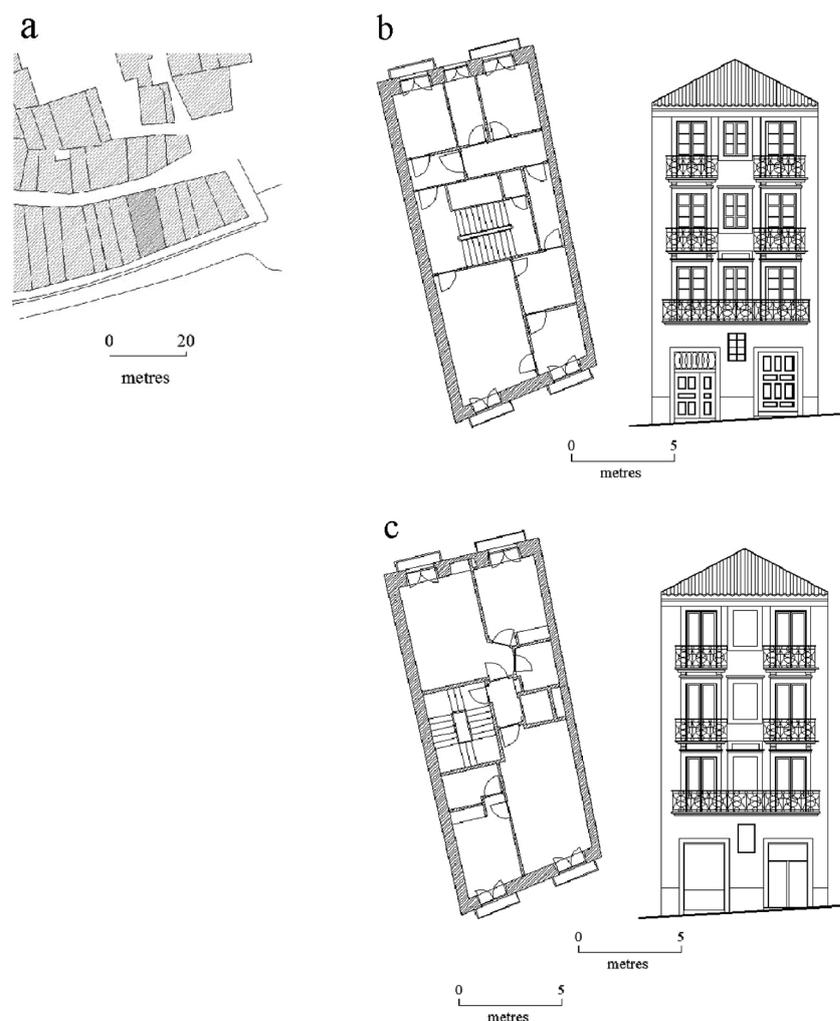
Transformação da estrutura interna e da fachada. Transformation of internal structure and facade. (a) Location plan. (b) Floor plan and northern facade before transformation. (c) Floor plan and northern facade after transformation. Sources: Oliveira et al., 2014.
